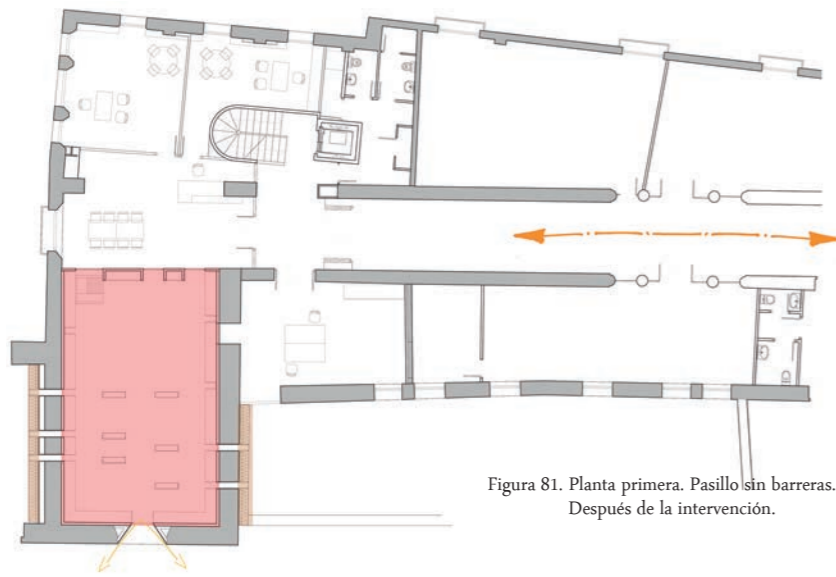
Planta primera. Pasillo sin barreras. Después de la intervención.
